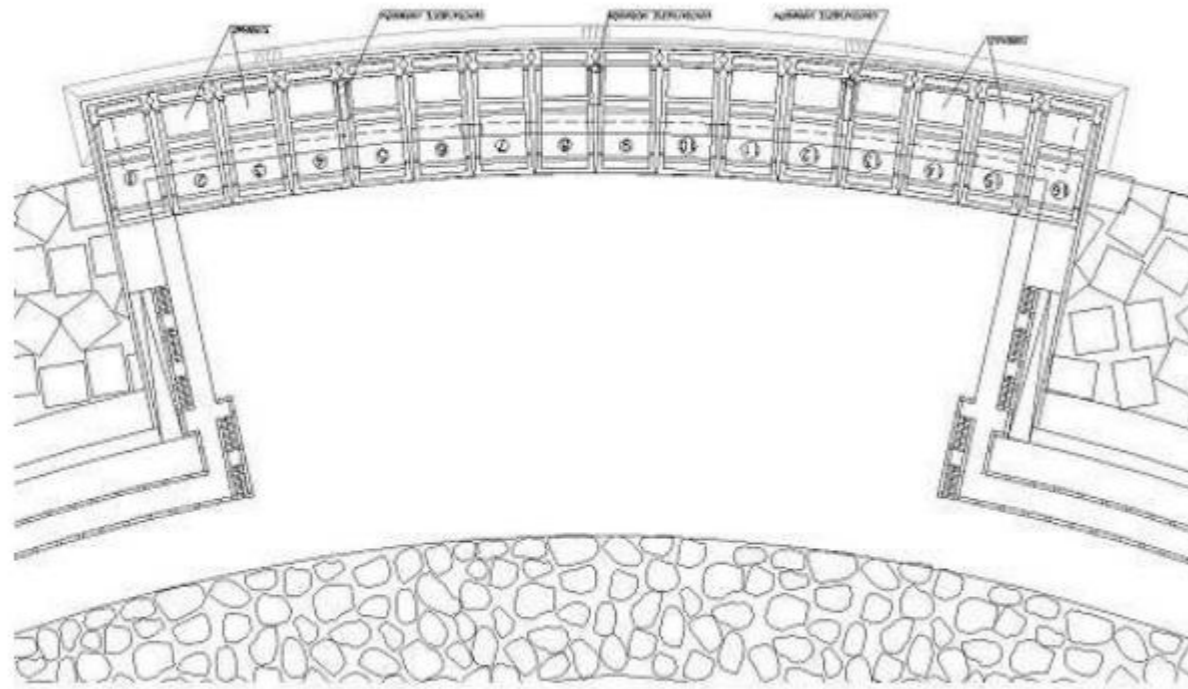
Planta de la Central Undimotriz de Mutriku [9]
